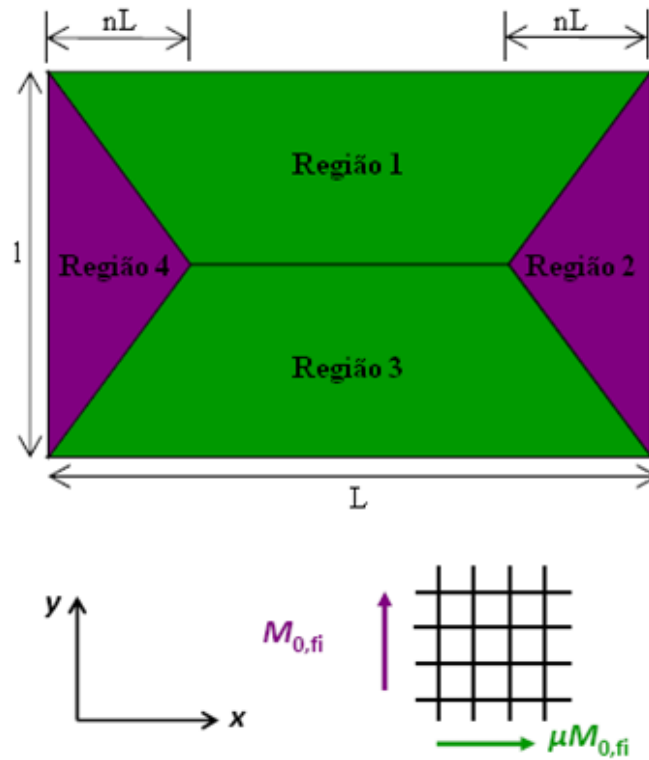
Padrão de linhas de rotura para uma laje retangular simplesmente apoiada.
